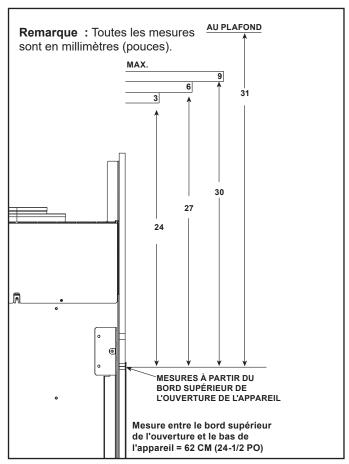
Dimensions des combustibles minimaux verticauxet maximaux horizontaux - CRAVE7260-C, CRAVE7260ST-C, CRAVE8472-C and CRAVE8472ST-C
